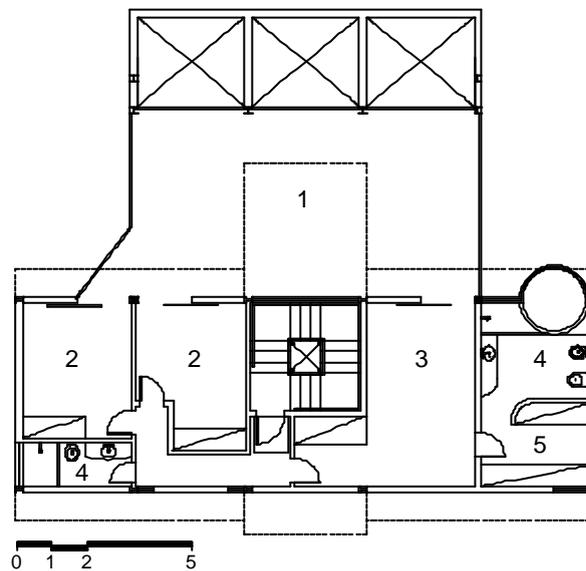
Projeto arquitetônico: planta do segundo pavimento
